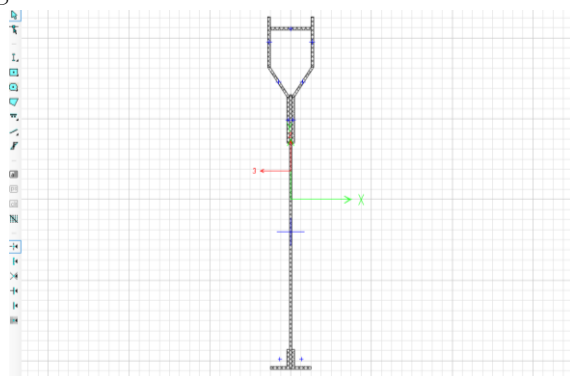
Ejemplo de definición de viga longitudinal de tablero con “Section Designer”
